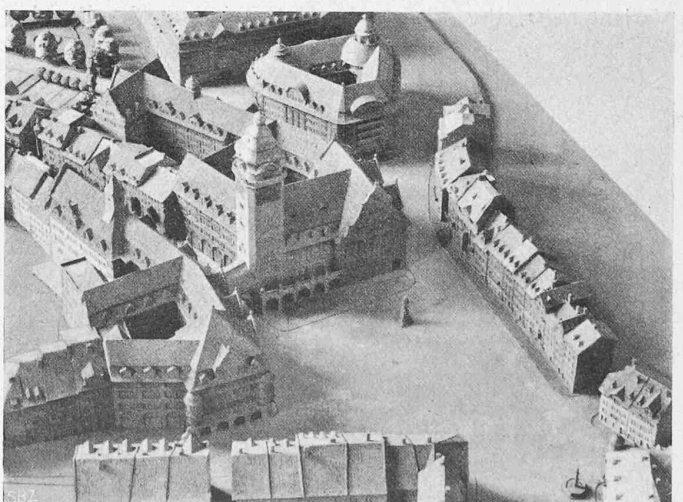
Projekt Max Müller 1913, Modellansicht gegen Westen.
